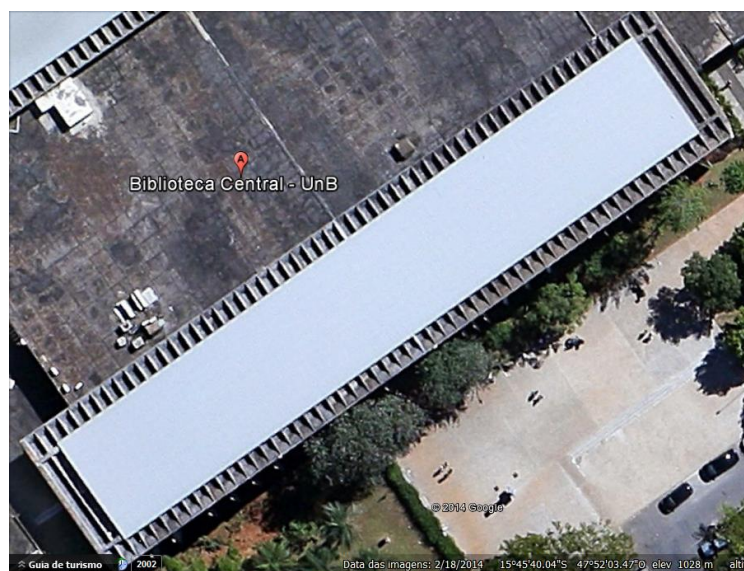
Vigas transversais na laje LC2 (Google Earth, 2014).
